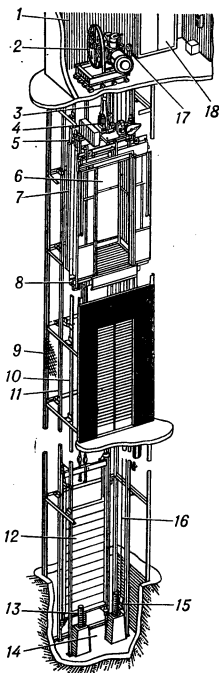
Схема пассажирского лифта: 1 — машинное помещение; 2 — лебёдка; 3 — рабочие канаты; 4 — подвеска; 5 — лебёдки; 6 — кабина; 7 — отводка; 8 — башмак; 9 — шахта; 10 — направляющие кабины; 11 — направляющие противовеса; 12 — противовес; 13 — буфер; 14 — приямок; 15 — натяжной блок; 16 — канат ограничителя скорости; 17 — ограничитель скорости; 18 — магнитная станция.
